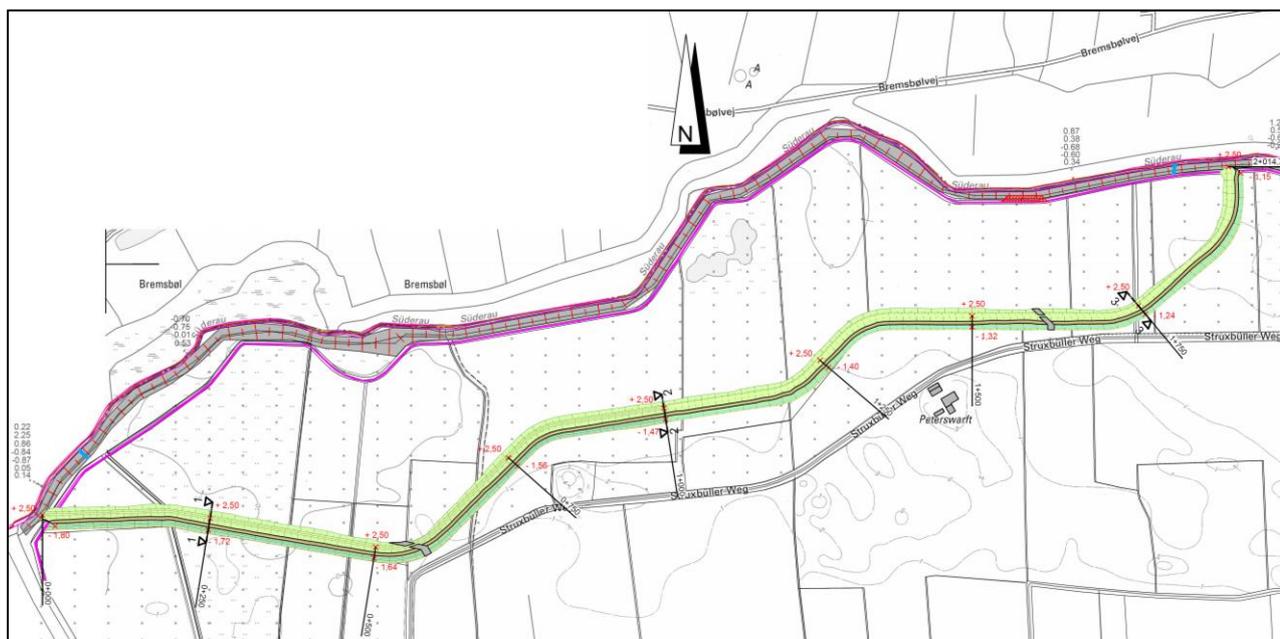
Lage des geplanten Deiches (grün) zur Herstellung des Retentionsraumes (ohne Maßstab). Auszug aus dem Übersichtslageplan zur wasserbaulichen Maßnahme, Reese + Wulf GmbH
